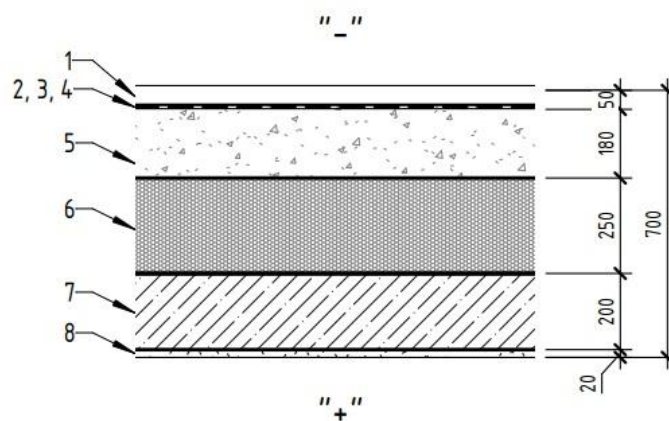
Конструктивна схема до теплотехнічного розрахунку перекриття: 1 - баластна гравійна засипка, 2 - геотекстиль термос кріплений, 3, 4 - ПВХ-мембрана, 5 - цементно-піщана стяжка, 6 - екструдований пінополістирол, 7 - залізобетонне перекриття, 8 - штукатурка
